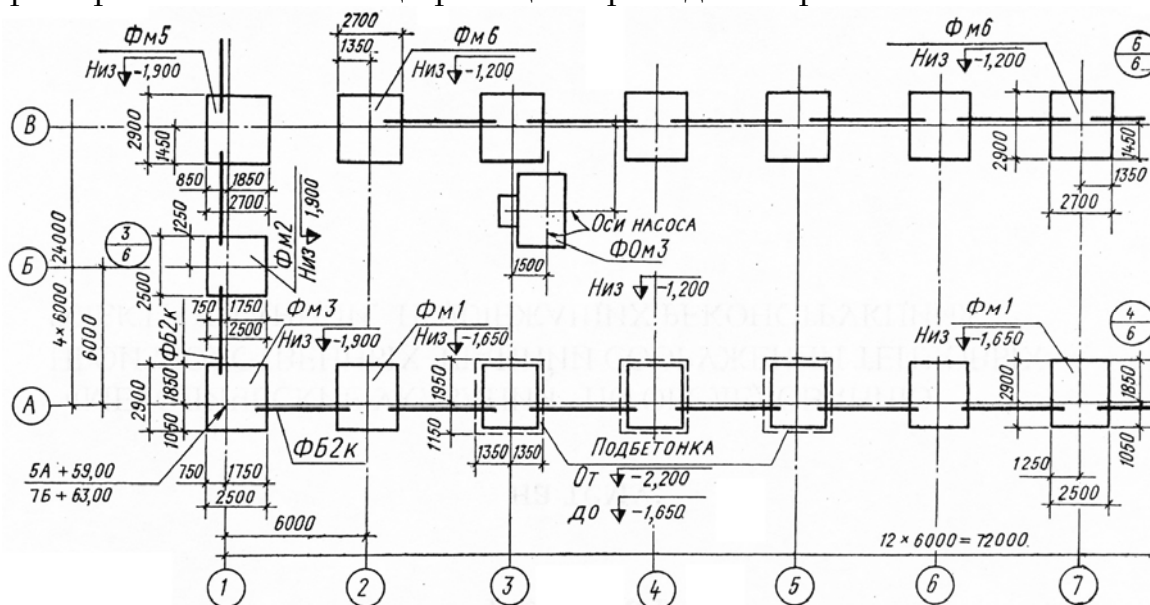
Маркировочная схема фундаментов и фундаментных балок
